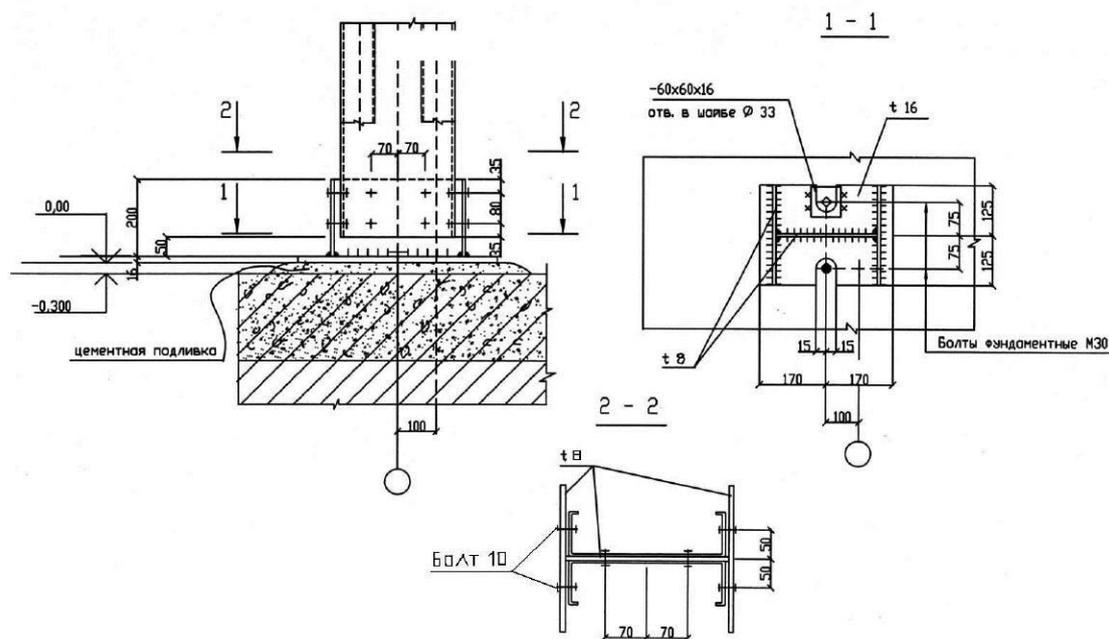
Схема крепления колонн из ЛСТК
